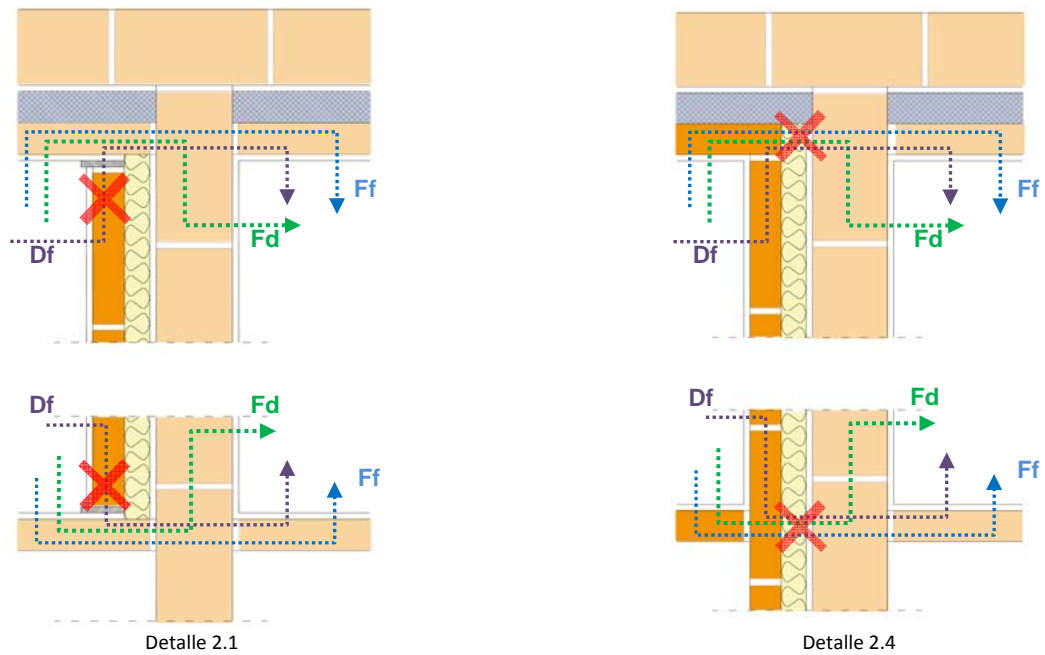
Detalle uniones montaje 2.1 (izquierda) y montaje 2.4 (derecha). En el montaje 2.1, las transmisiones flanco-directo (Fd) y flanco-flanco (Ff) son dominantes, tanto en la unión de fachada, como en la unión de tabiquería. La transmisión directo-flanco (Df) se reduce por el efecto de las bandas elásticas. En el montaje 2.4, la desconexión de la tabiquería y del trasdosado de fachada respecto de la hoja de ladrillo perforado minimizan las transmisiones indirectas.
